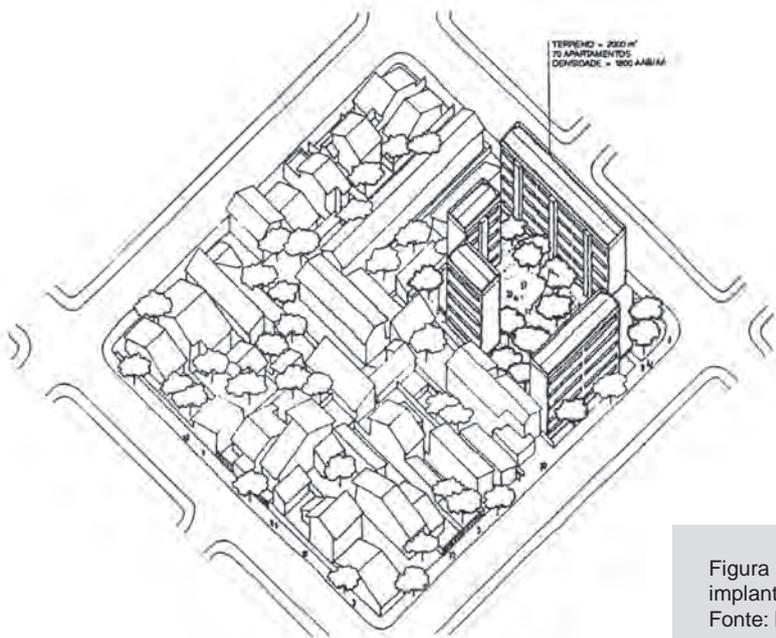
Proposta de projeto para implantação dos novos conjuntos habitacionais
